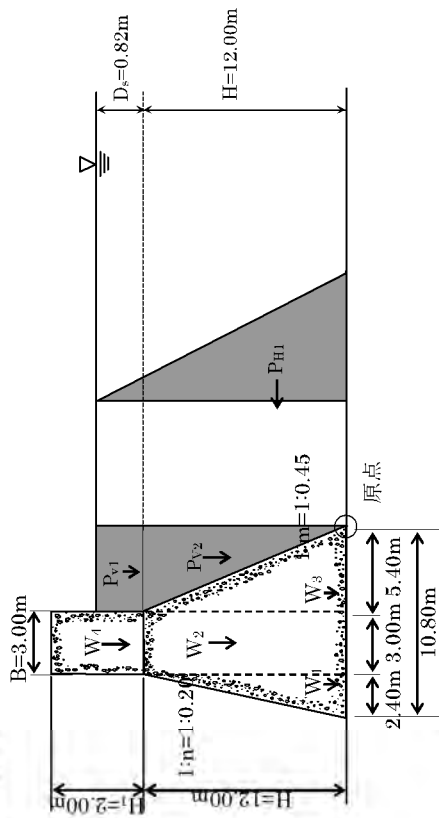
砂防堰堤に作用する力 (断面 (3) : 洪水時)
